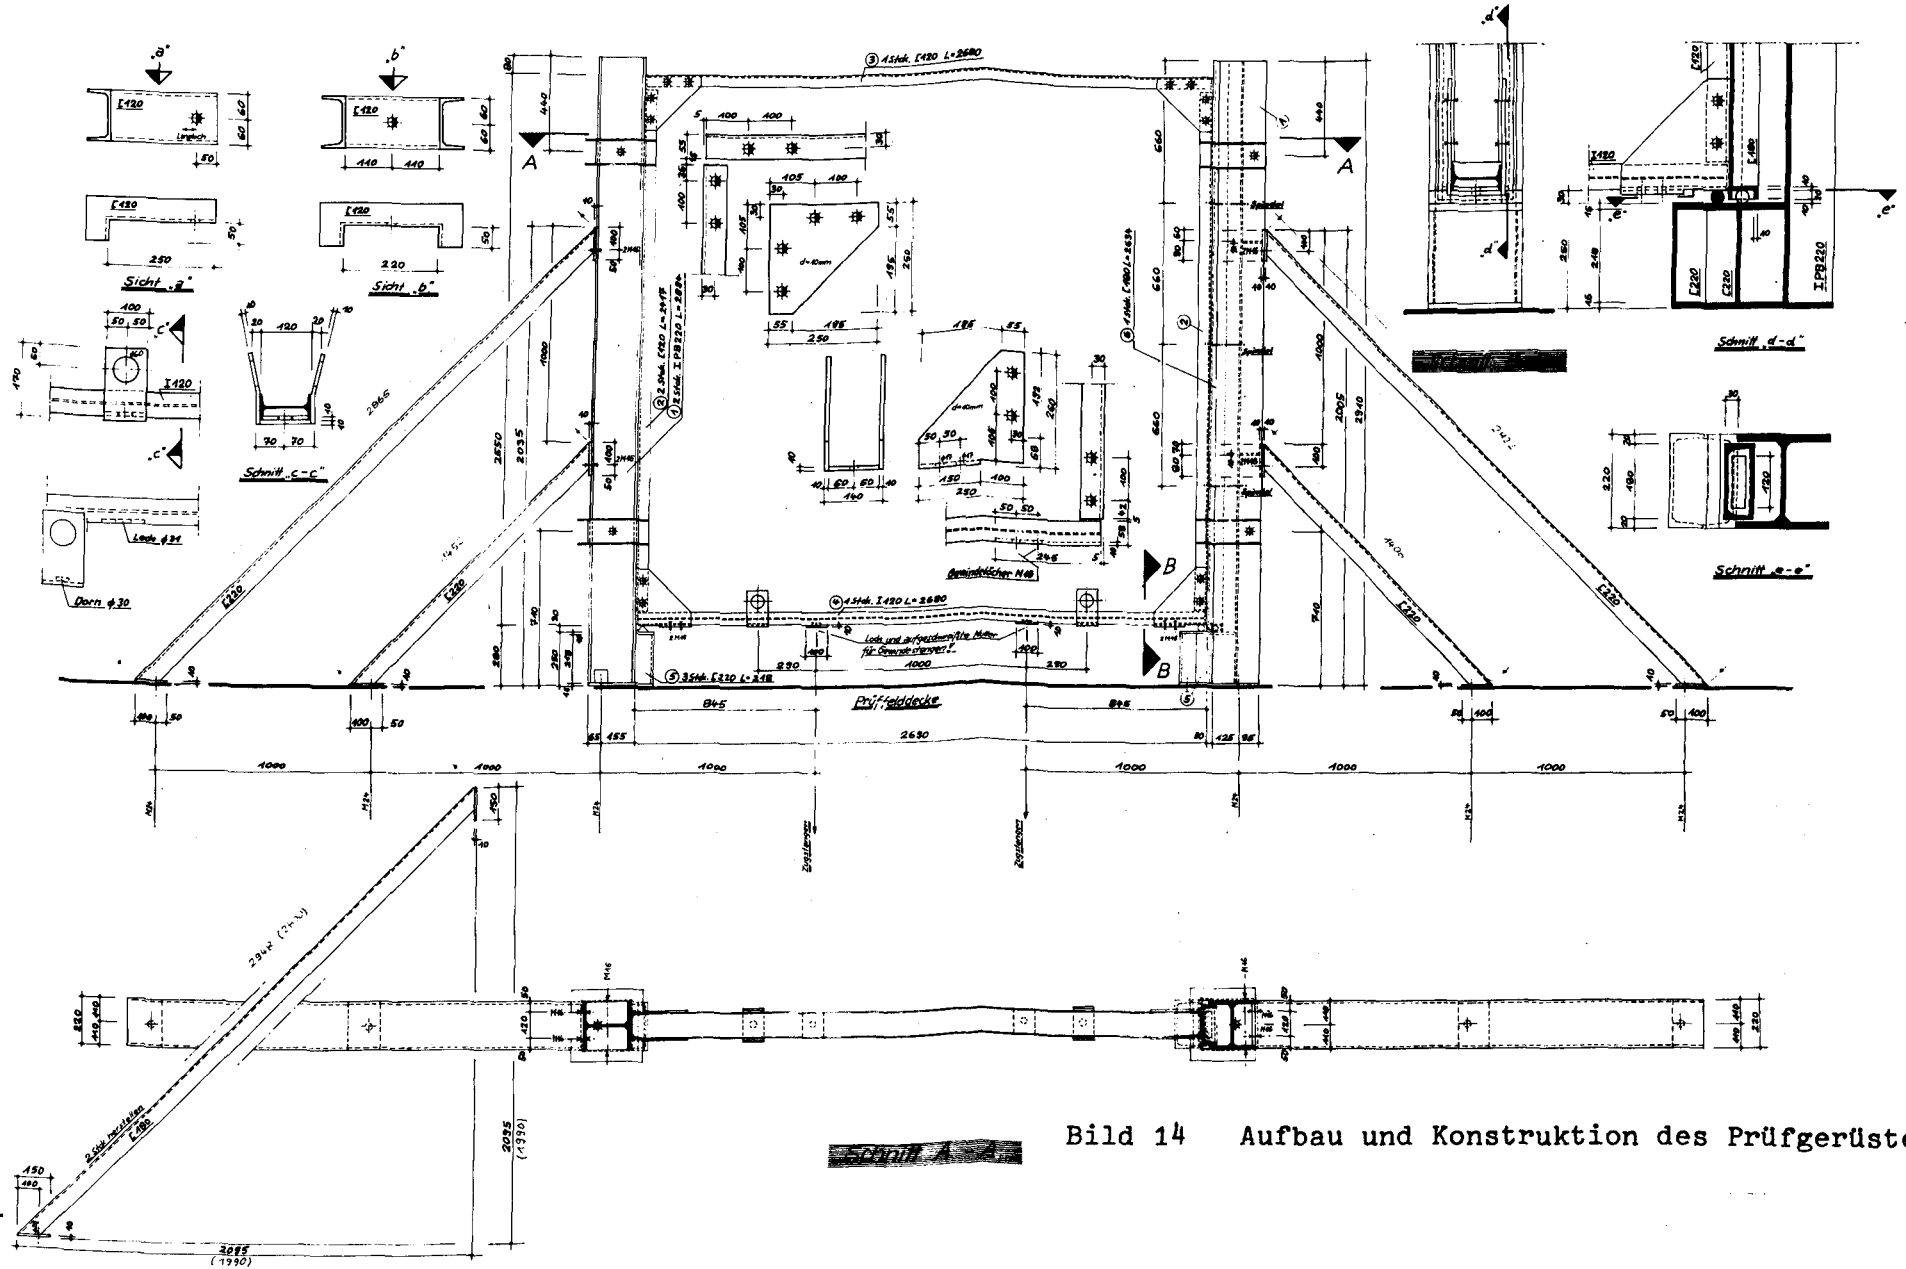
Aufbau und Konstruktion des Prüfgerüsts
